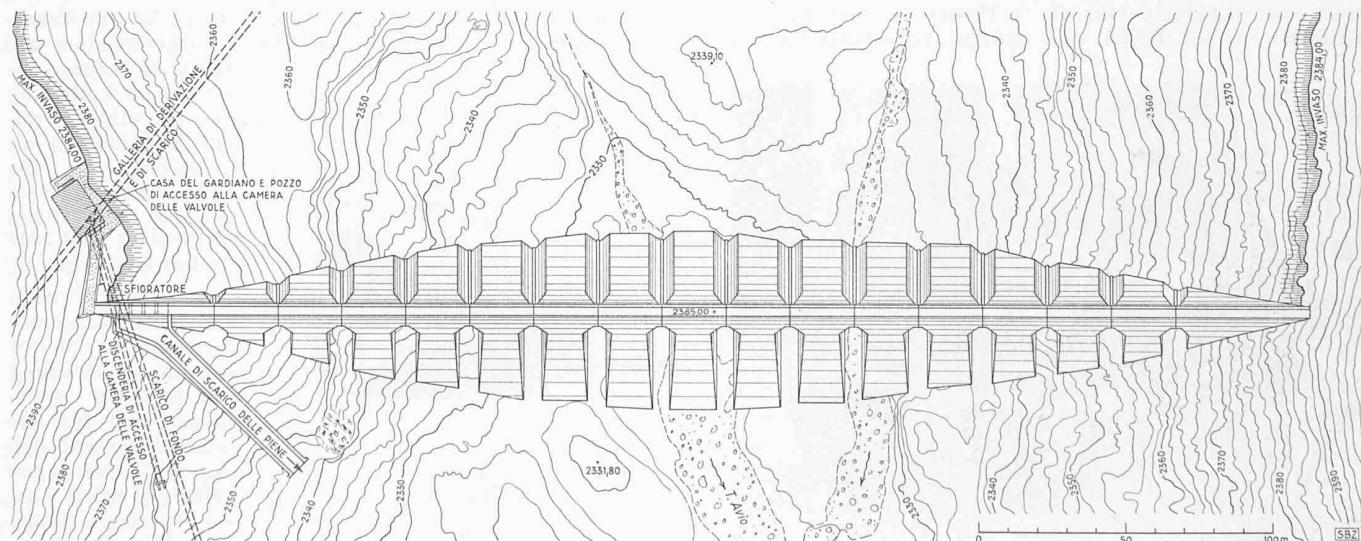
Pfeilerstaumauer für den Stausee Pantano d'Avio. Situation 1:2500
